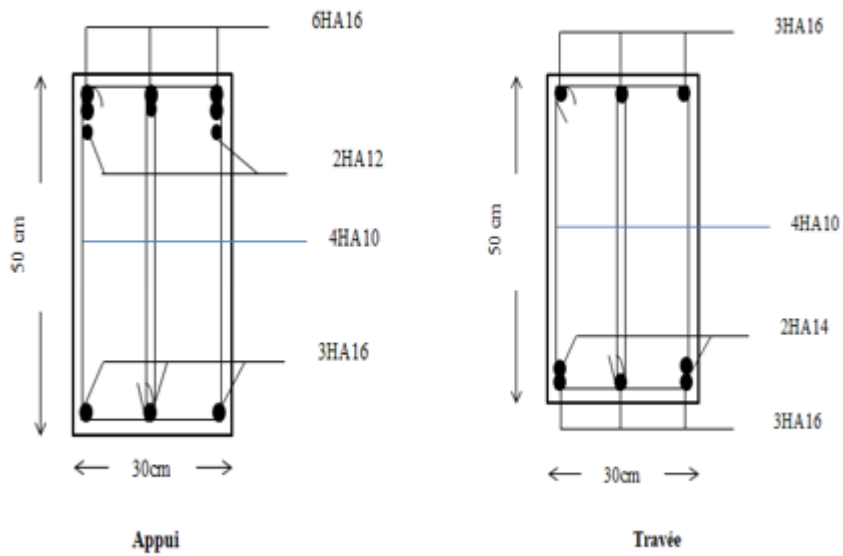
Schéma de ferrailage des poutres porteuses du (RDC au 6^{ème}) étage.
